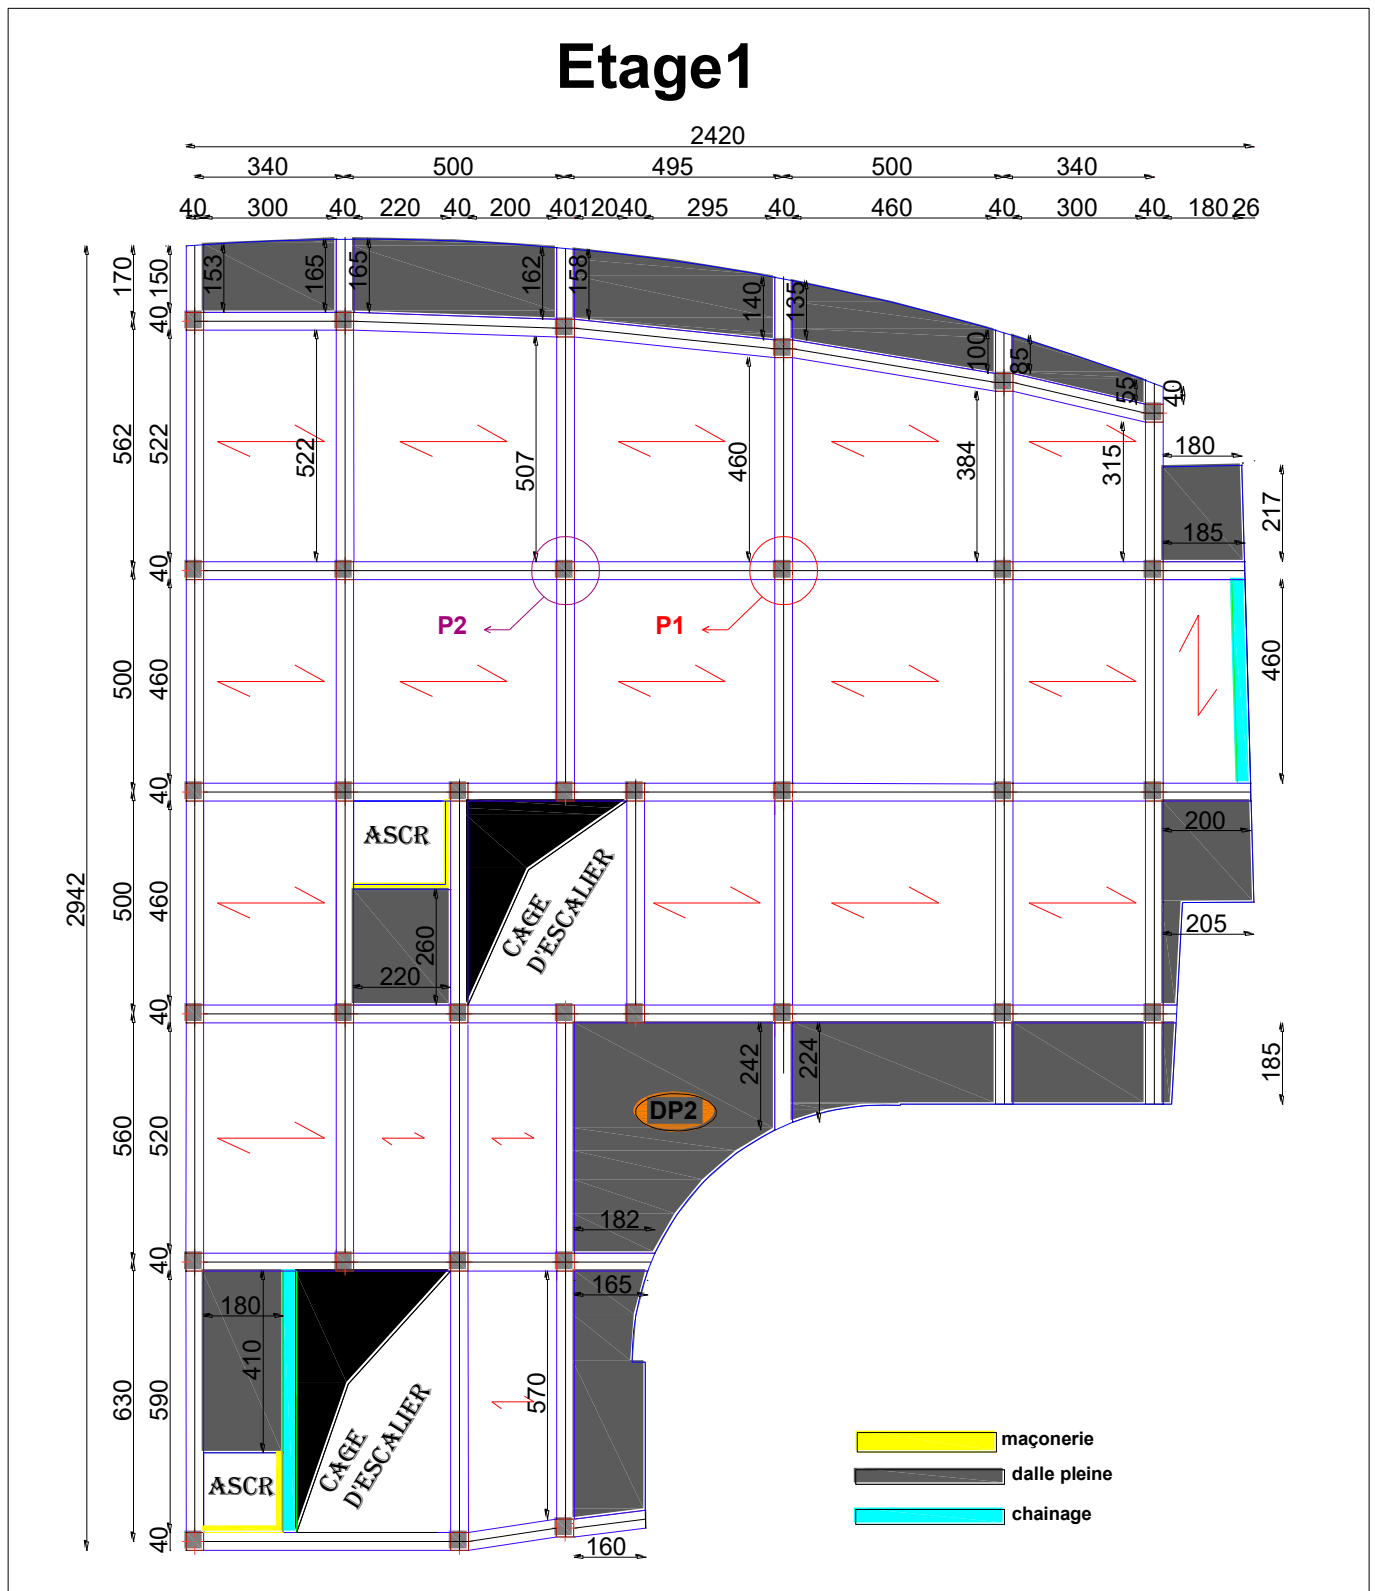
Plan de disposition des poutrelles et emplacement des dalles pleines étage 1.
